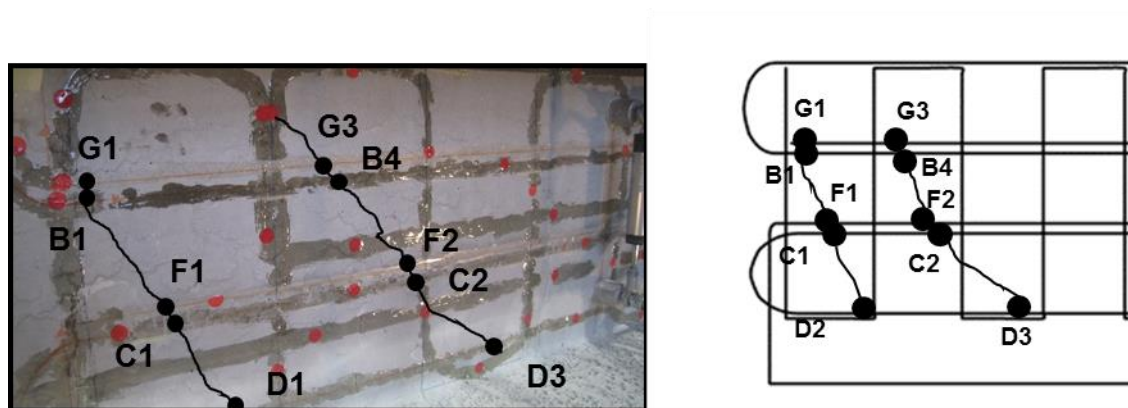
Conformación del patrón real de fisuración y el calculado en el ensayo la viga I-1 a una carga de 187 kN
